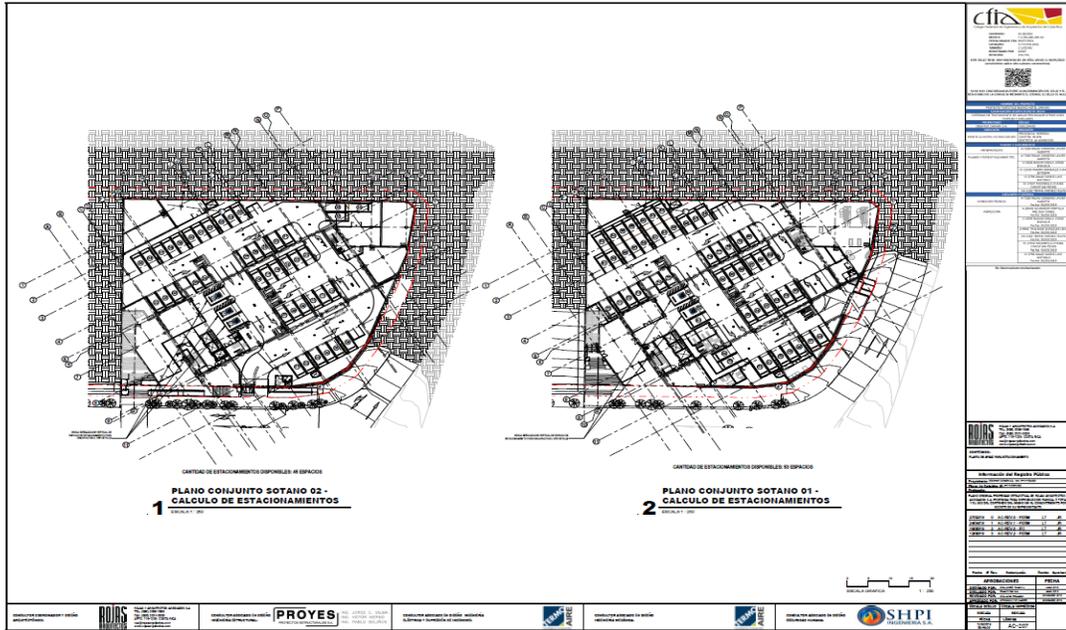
Planta de Conjunto Sotanos de Hotel, referencia planos constructivos, lámina # AC-207.
